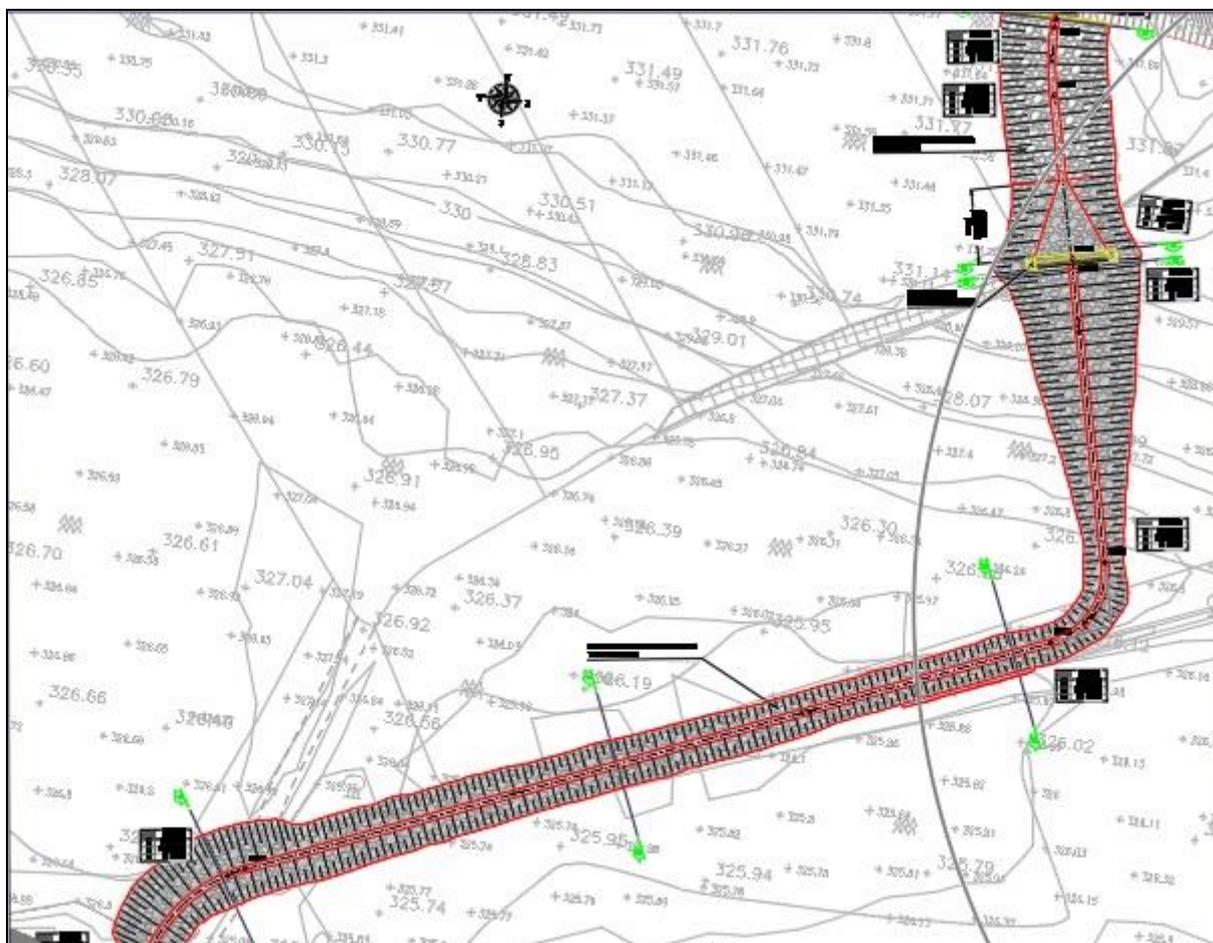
Inalveazione IN01 – Tratto di valle: Pianta
